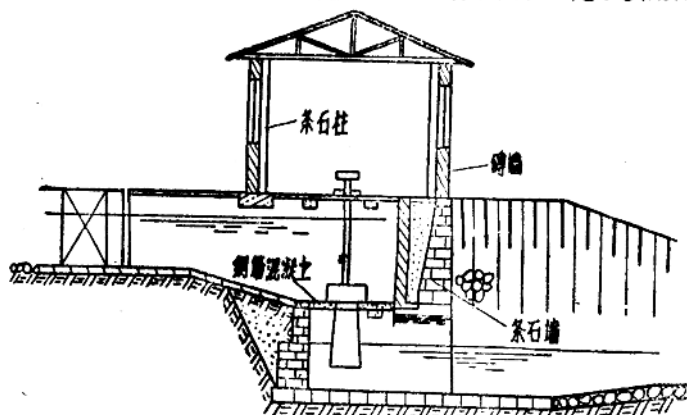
用钢筋混凝土及条石柱、条石砌牆的厂房
